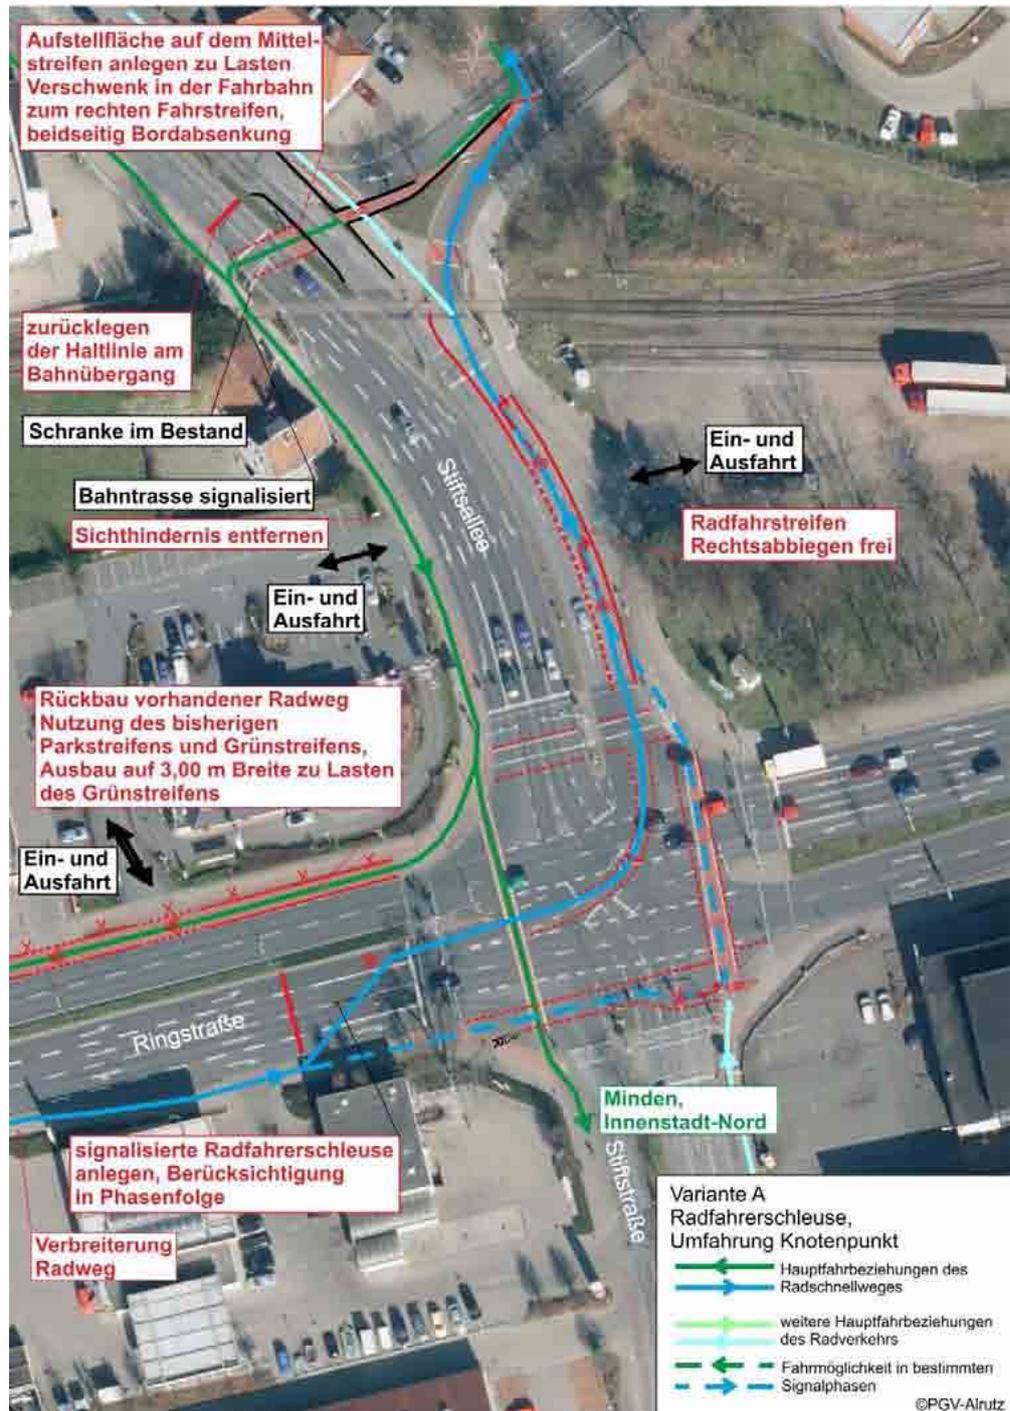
Bereich Ringstraße, Stiftsallee, Gleisstraße. Variante A
